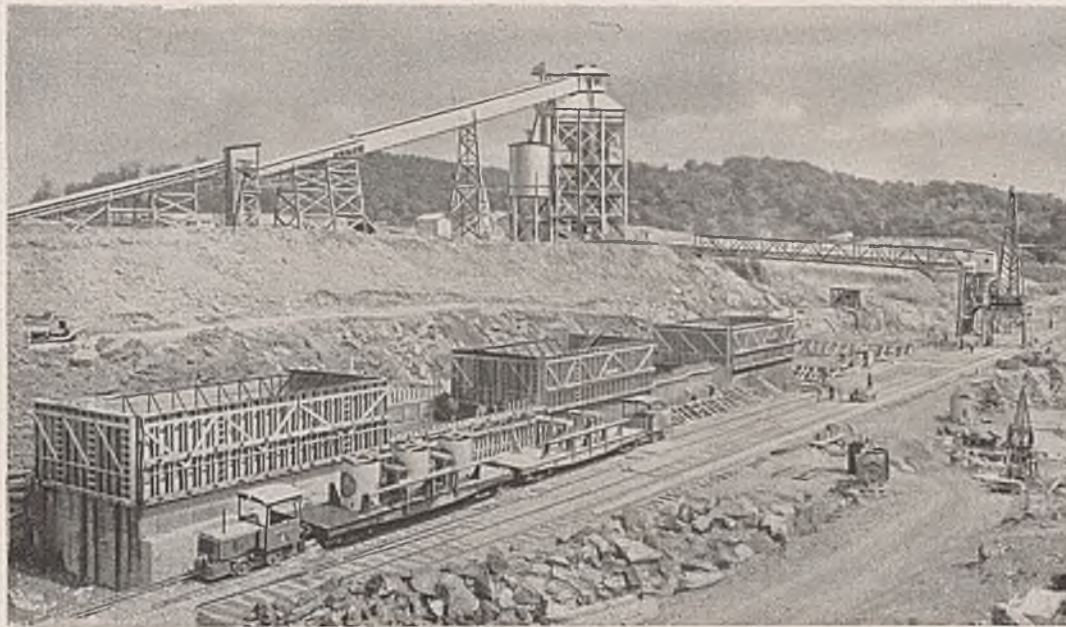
Schleusenbaugrube mit Mischanlage, Zubringerband, Kübel-Plattformwagen und Portal-Drehkränen zur Betoneinbringung.
